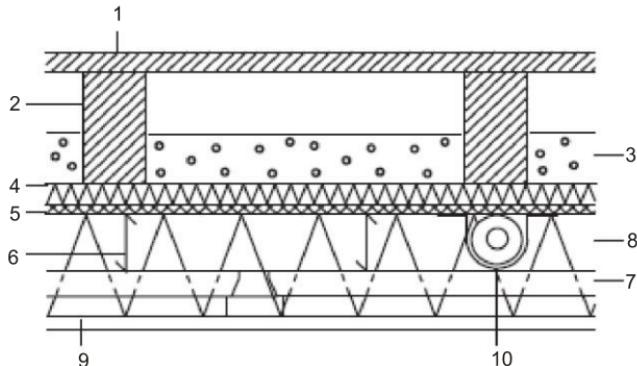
Подвесная конструкция под перекрытием из деревянных балок с проведением трубопровода через слой теплоизоляции (поперечный разрез): 1 — дощатый пол; 2 — балки перекрытия; 3 — засыпка; 4 — слой под штукатурку; 5 — штукатурка (стыки герметично заделаны); 6 — система подвесок; 7 — упругие рейки; 8 — теплоизоляция; 9 — гипсокартон; 10 — трубопровод
